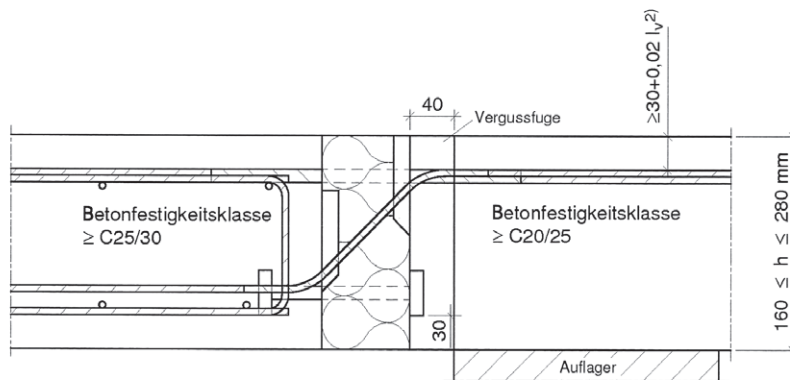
Beispiel Schöck Isokorb Typ RK-239 in eingebautem Zustand mit Aufhängebewehrung nach Abschn. 3.3.1, Z-15.7-239 und Vergussfuge
